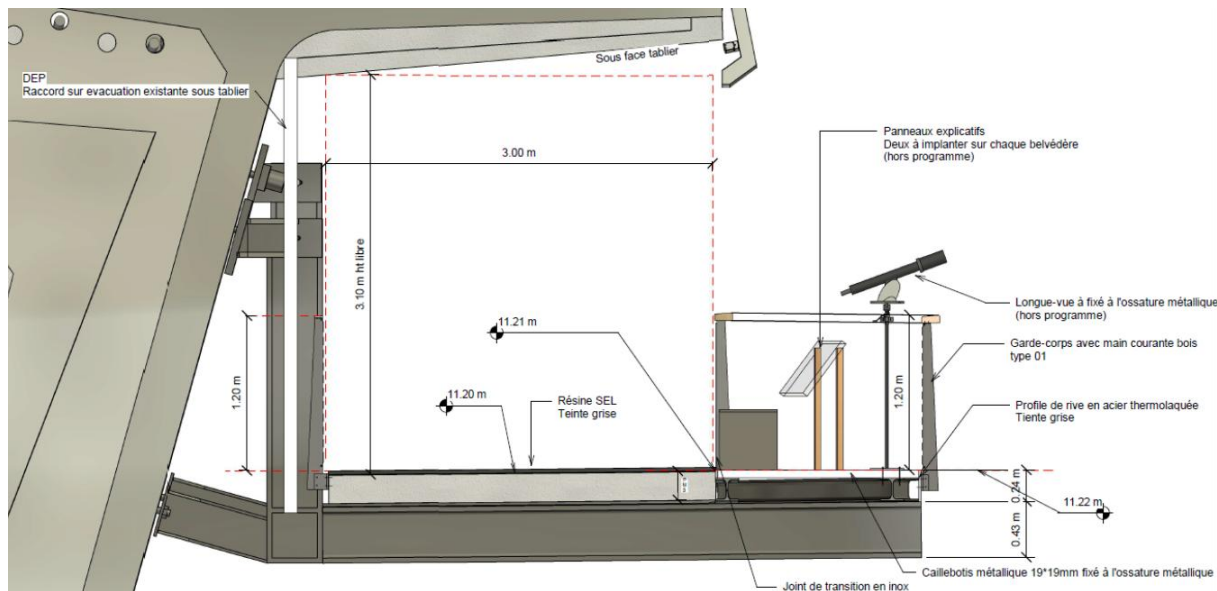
Extrait du cahier de plans architecturaux pour voussoir sur pile avec belvédère
